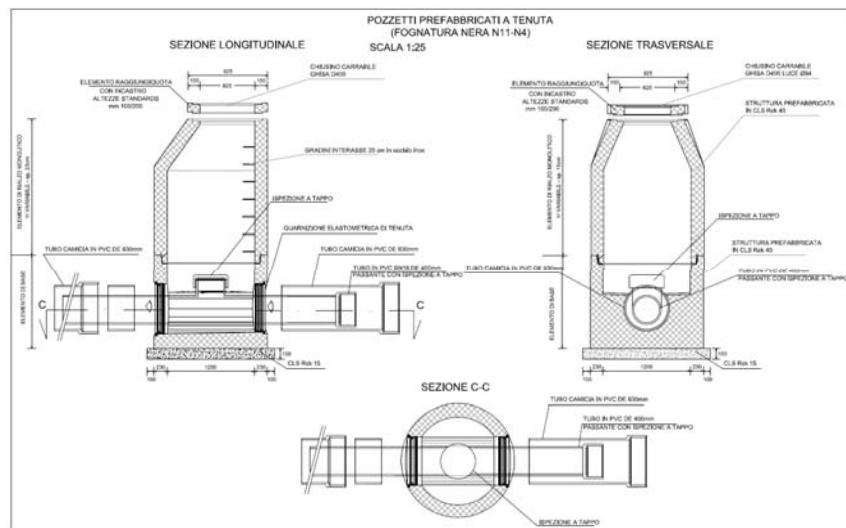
Pozzetti prefabbricati a tenuta nel tratto di interferenza con la zona di rispetto allargata
